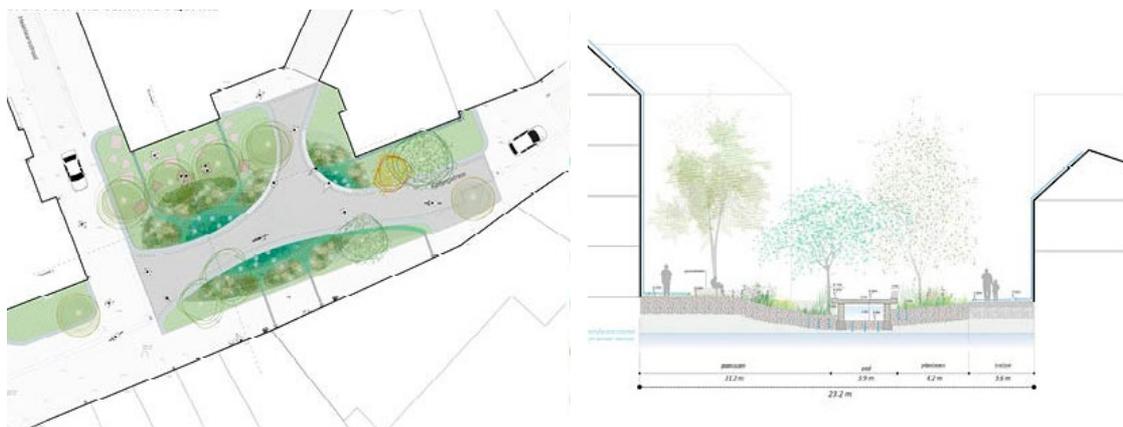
Planimetria di progetto e sezione trasversale della Kettingplein (Source: De Urbanisten, Omgeving)
